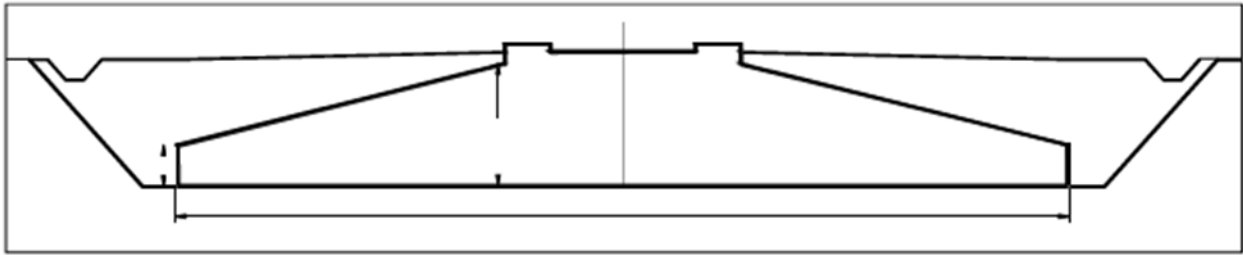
Tipico sezione fondazione Aerogeneratore
